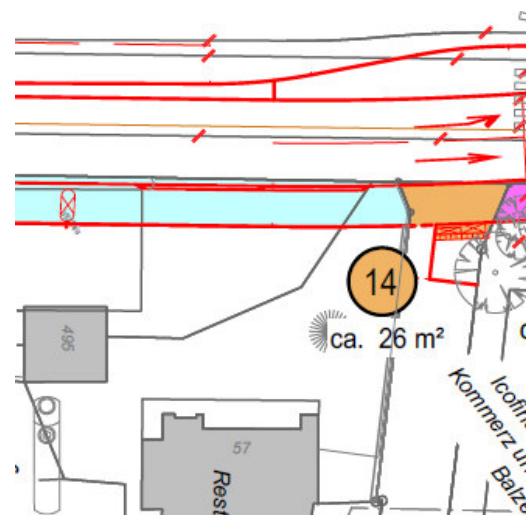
Planausschnitt Zürichstrasse / Kat.Nr. 5781,
